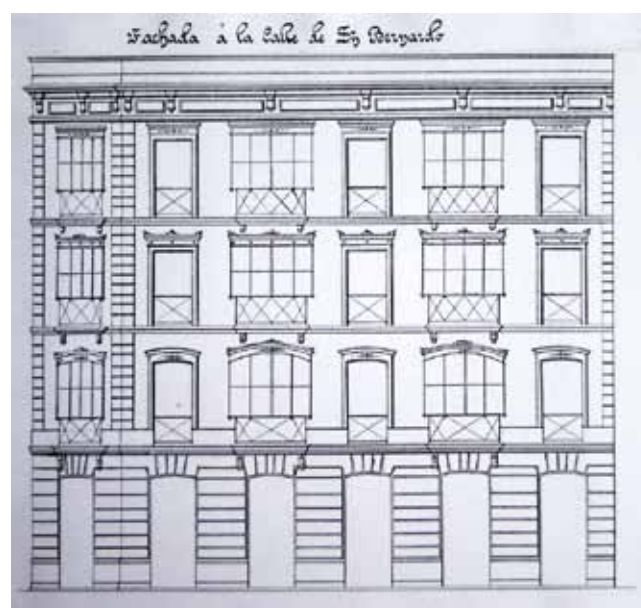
Edificio de M. F. Tuñón, alzado a la calle San Bernardo, Gijón. (R)
